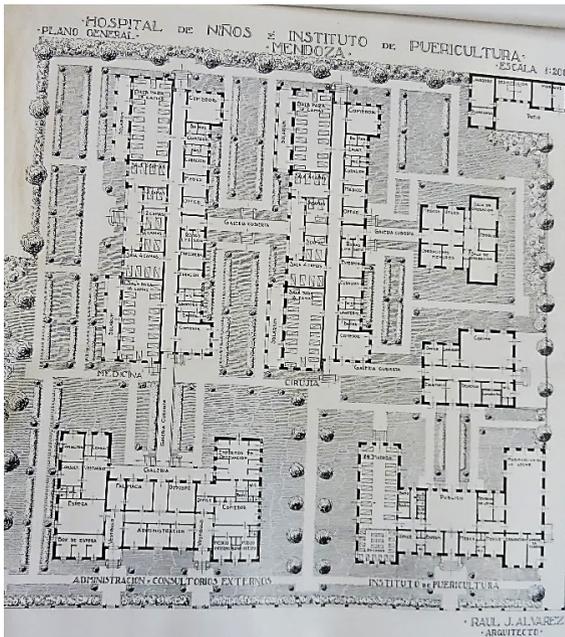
Plano de arquitectura del Hospital de niños, 1927.
